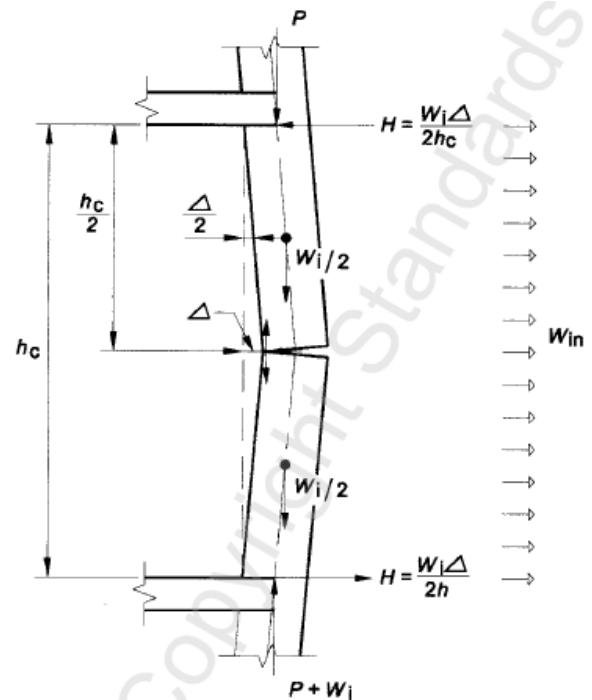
Fuerzas en muro con carga, incluyendo reacciones laterales
